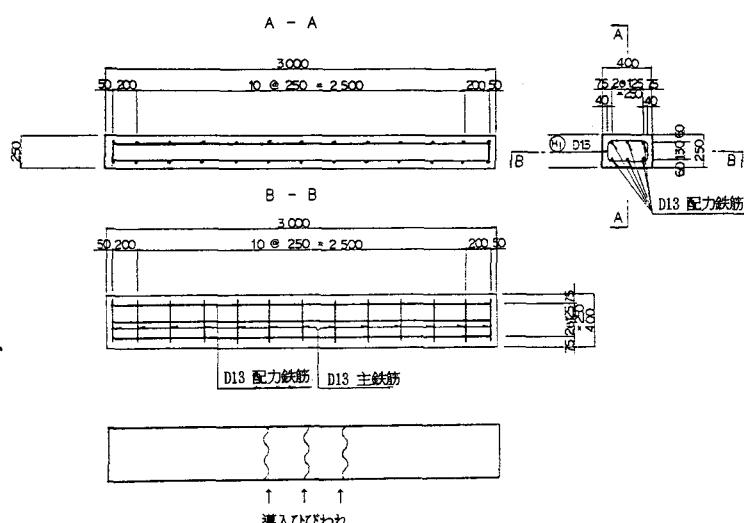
供試体寸法、配筋およびひびわれ導入状況
